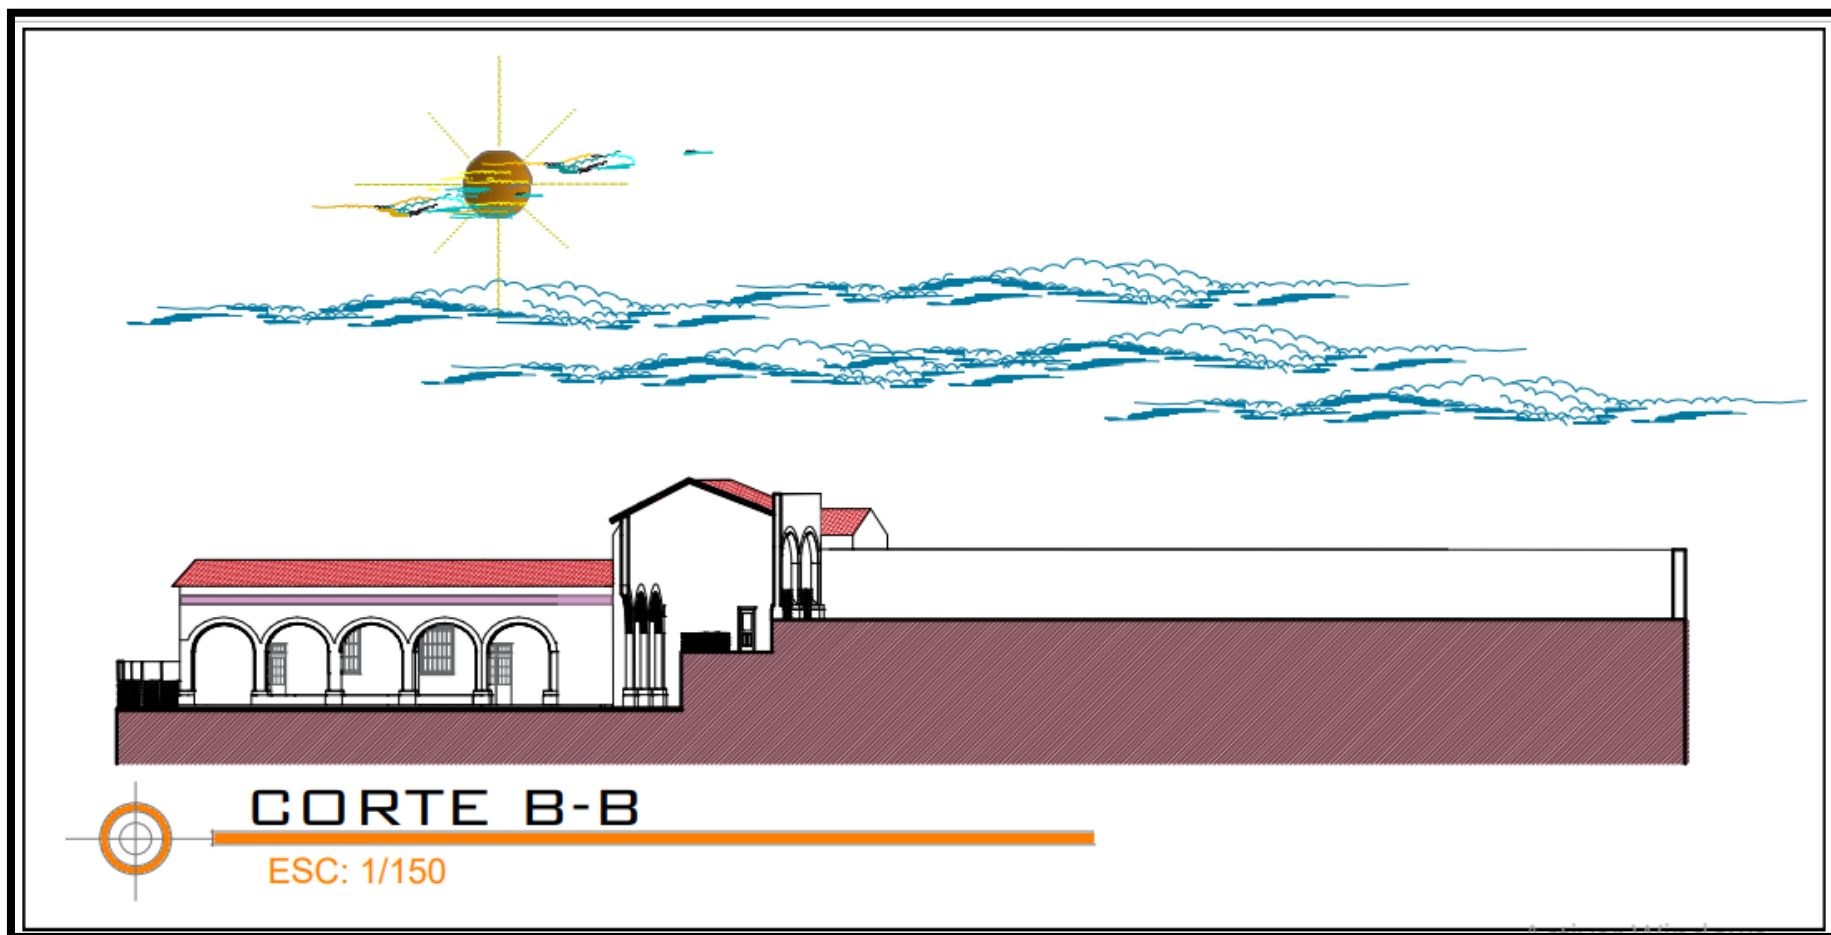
Plano de corte general de la hacienda Vichaycoto sección B-B.
